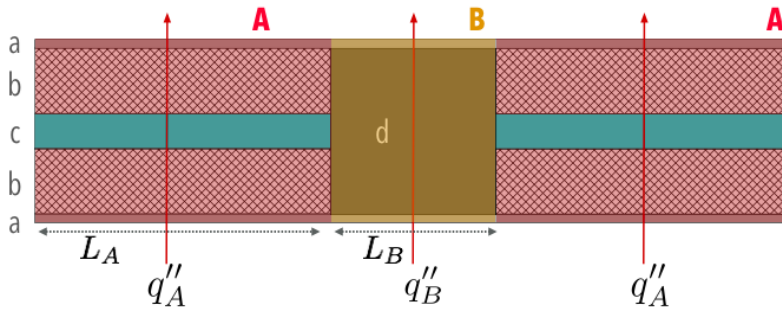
Elementos de uma parede dupla com isolamento térmico entre panos de alvenaria com pilar de betão (vista em planta).
